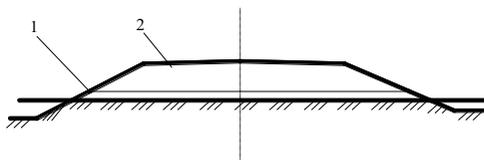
Поперечник насыпи с капилляропрерывающей подстилкой:
